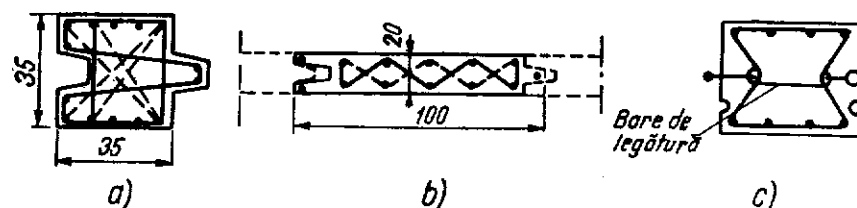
Palplanșe prefabricate din beton armat :
